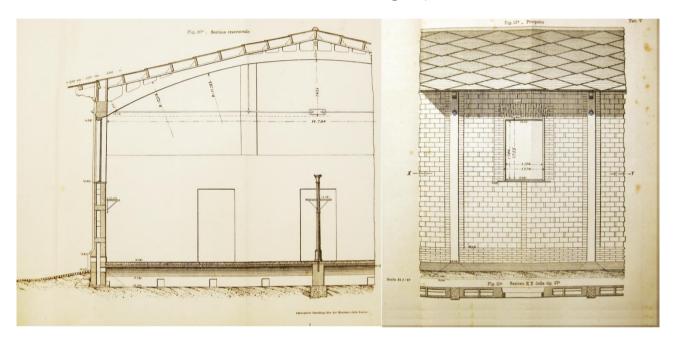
Sezione e prospetto della seconda baracca realizzata a Santa Croce in Gerusalemme; è visibile la differente soluzione costruttiva adottata per le pareti perimetrali (Caveglia 1906).
